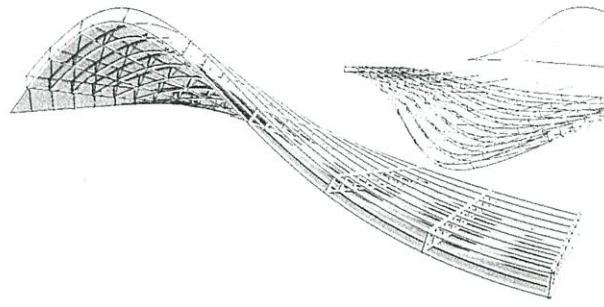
ภาพแสดงลักษณะของ Truss Structure
